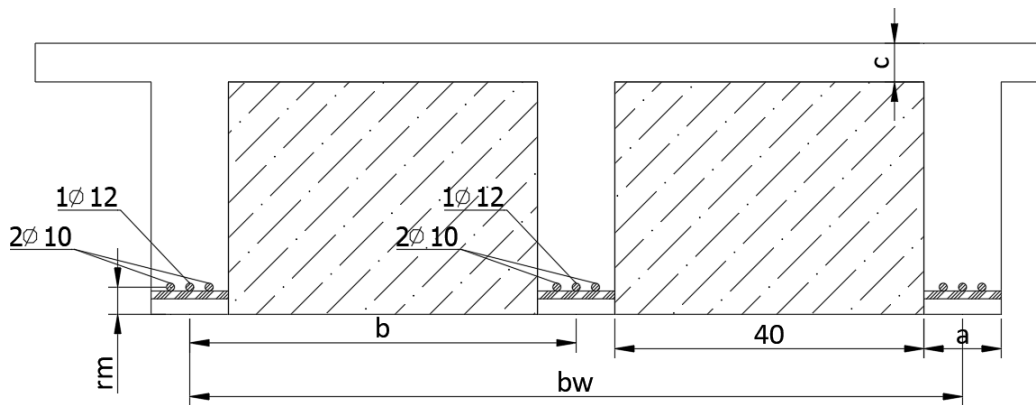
Disposición de armadura para M_y máximo positivo.
